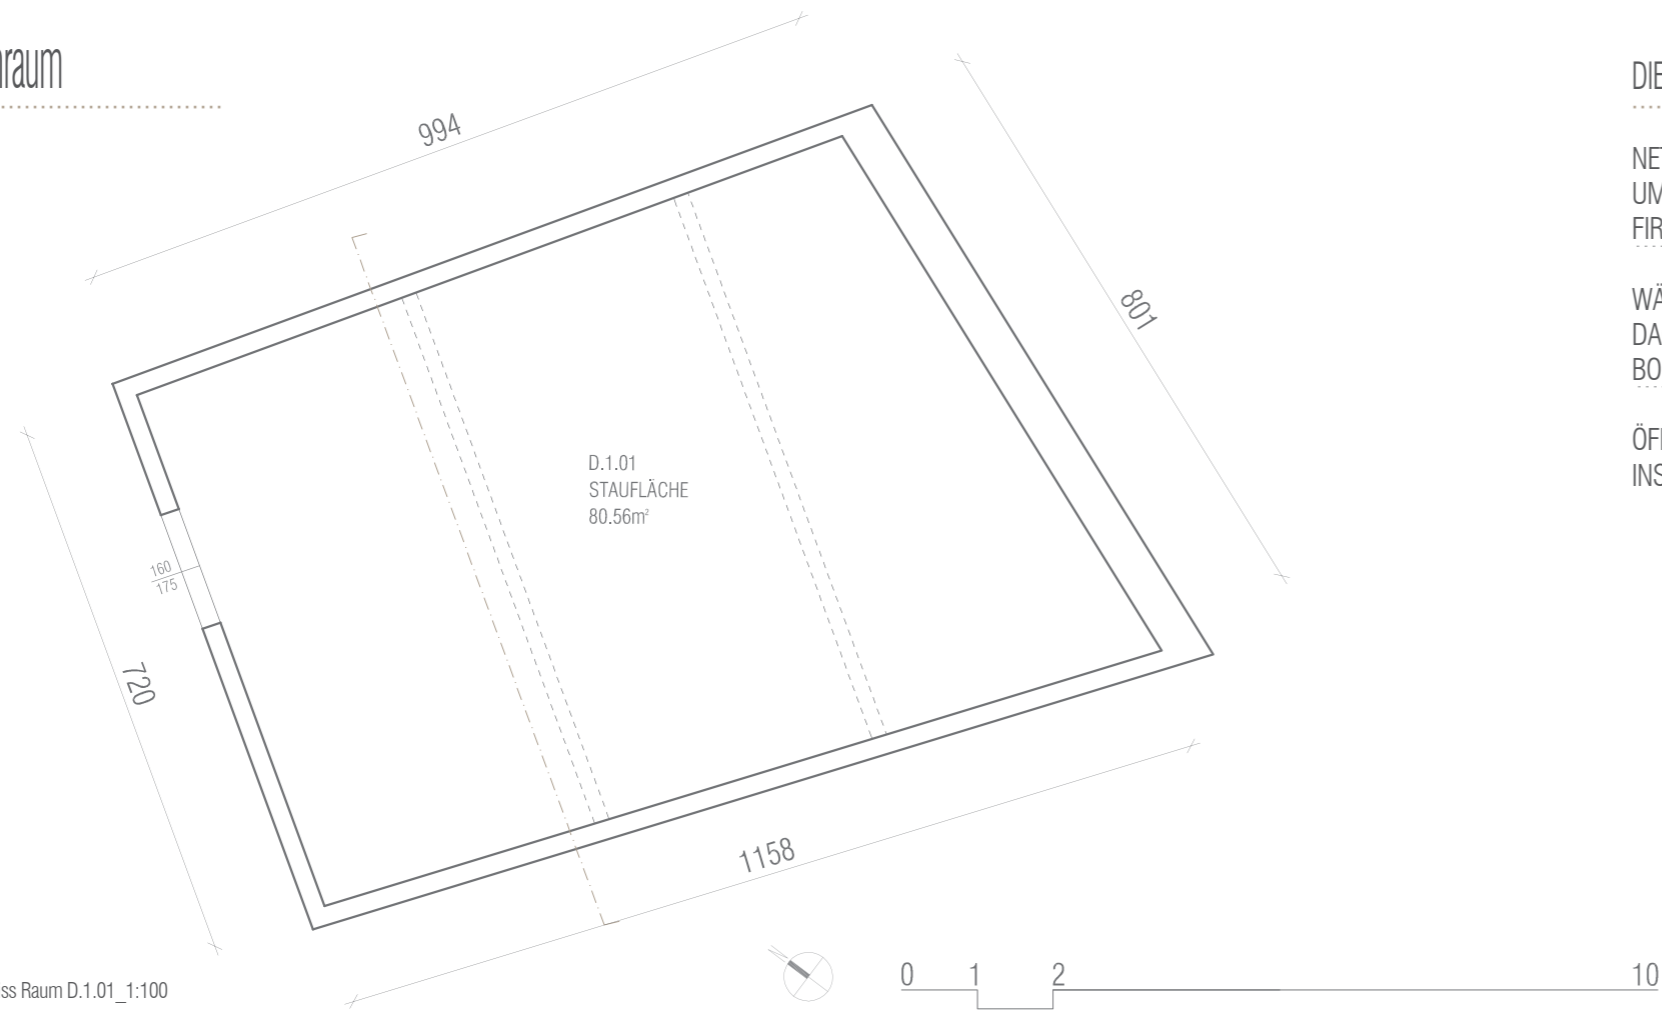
Grundriss Raum D.1.01_1:100
